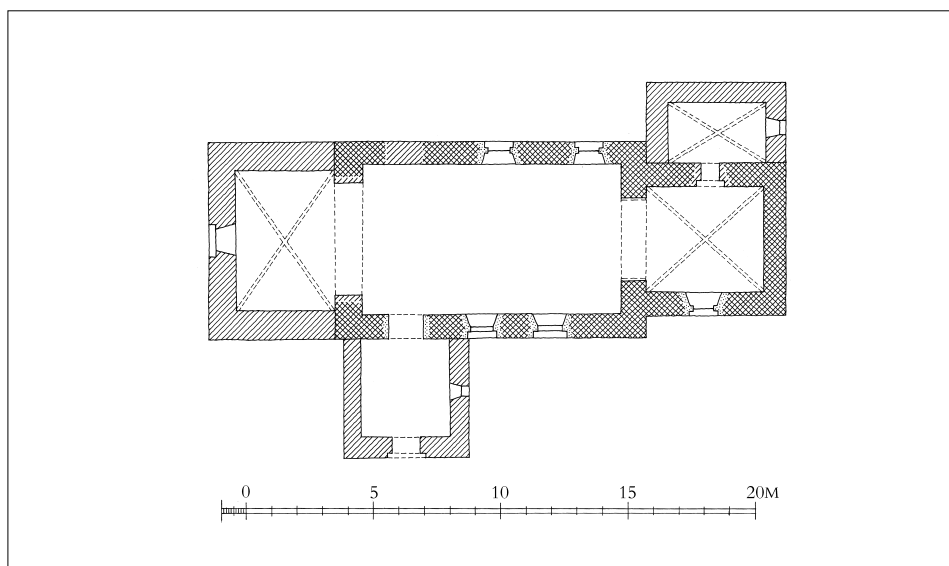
Den nedrevne †kirke. 1:300. Rekonstrueret grundplan, tegnet af Merete Rude 2014 efter opmåling af L. A. Winstrup 1881 (sml. fig. 8). – *The demolished church. Reconstructed ground plan.
